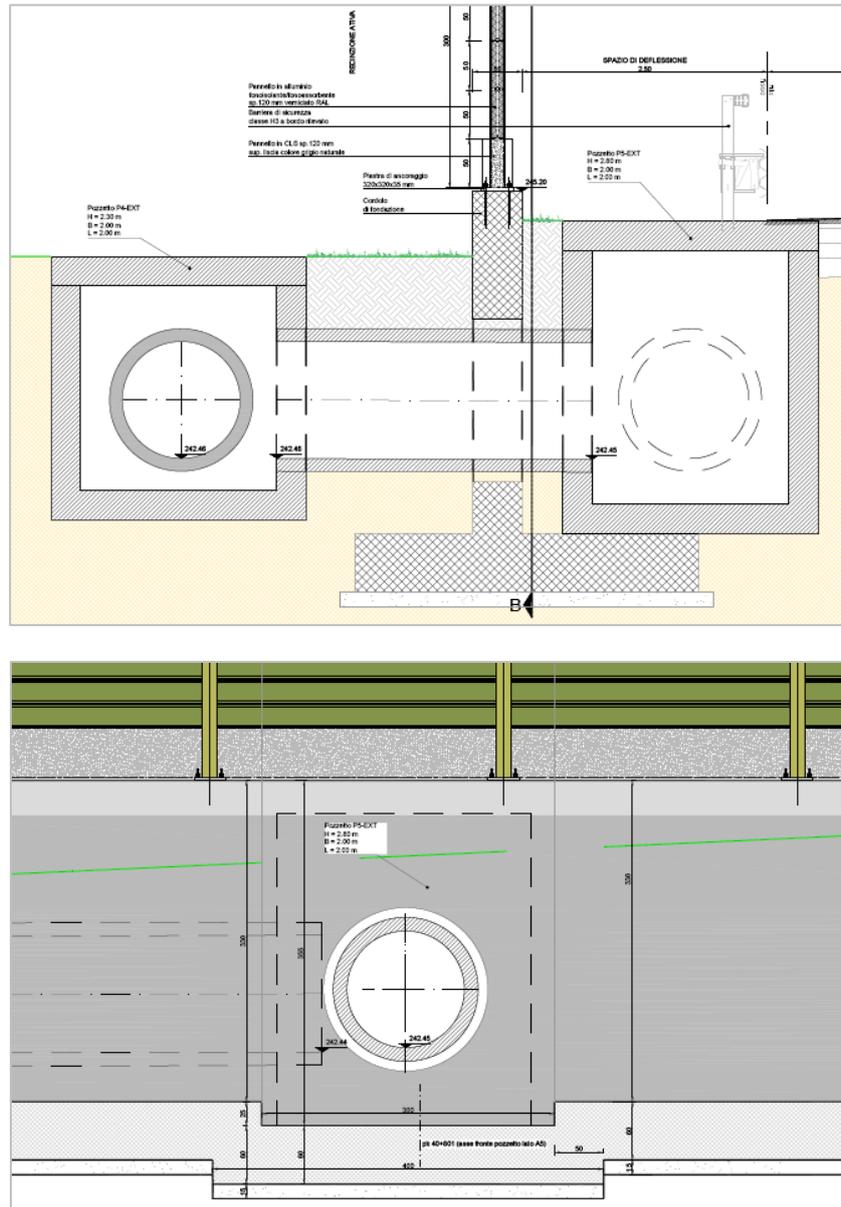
/3 e 2.8.4 - Fondazione tipo 1 – Barriera BA03 – Progressiva 40+801 - Attraversamento della fondazione da parte di tubo di raccolta delle acque di piattaforma – Sezione e prospetto
